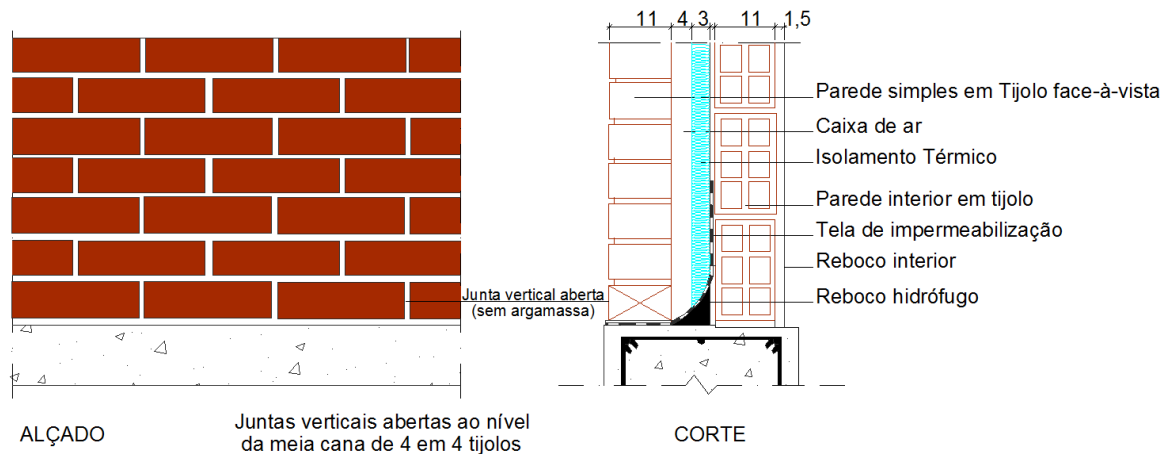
Esquema da constituição das paredes em tijolo face-à-vista
